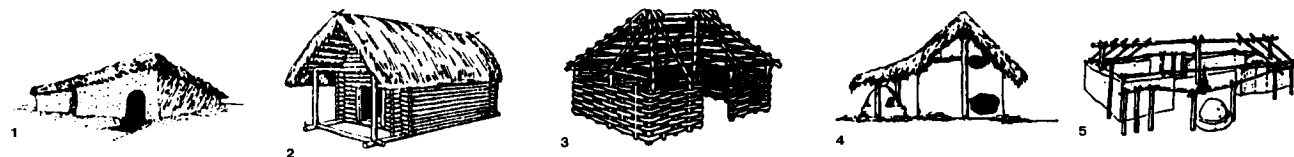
Типы жилищ среднего бронзового века: 1 – полуземлянка со стенами из плетня; 2 – каркасный дом (точное расположение стыков определено при раскопках); 3 – дом со стропильной крышей и плетеными стенами, обмазанными глиной; 4, 5 – детали конструкции дома поз. 3 (по Kovács, 1977)
